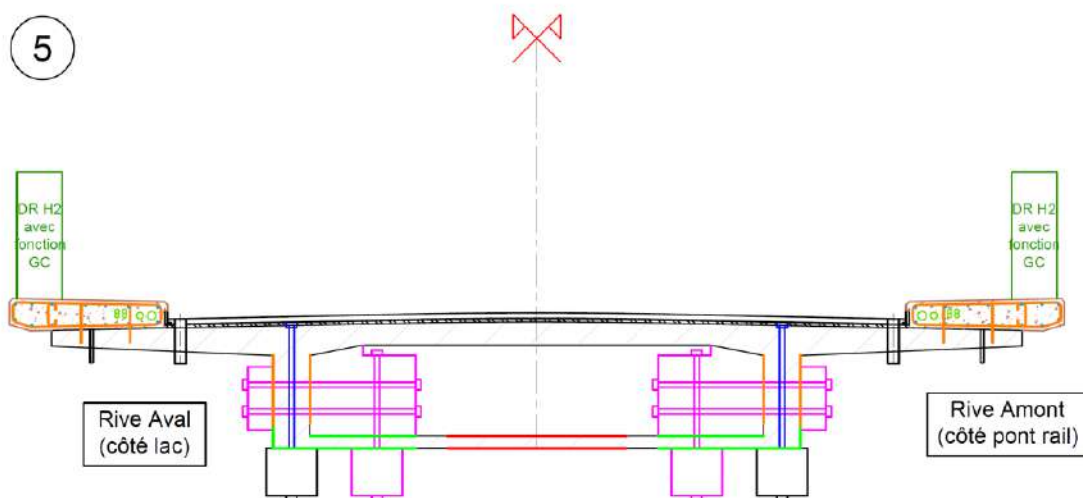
Coupe schématique transversale au niveau d'une clé avant et après travaux.
